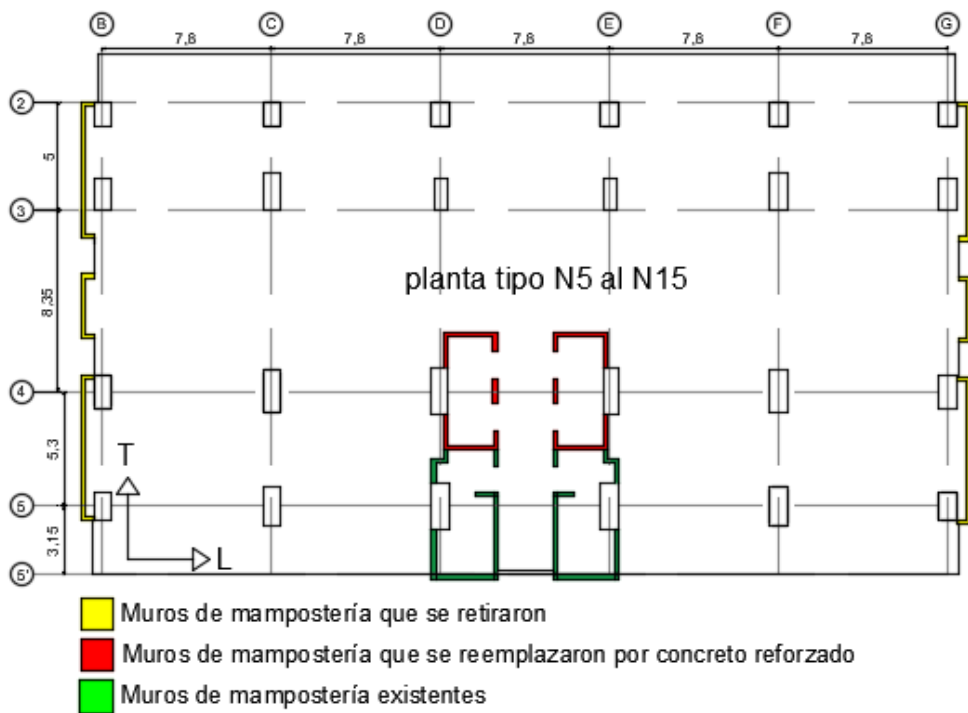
Muros de mampostería que se construyeron en el proyecto original
